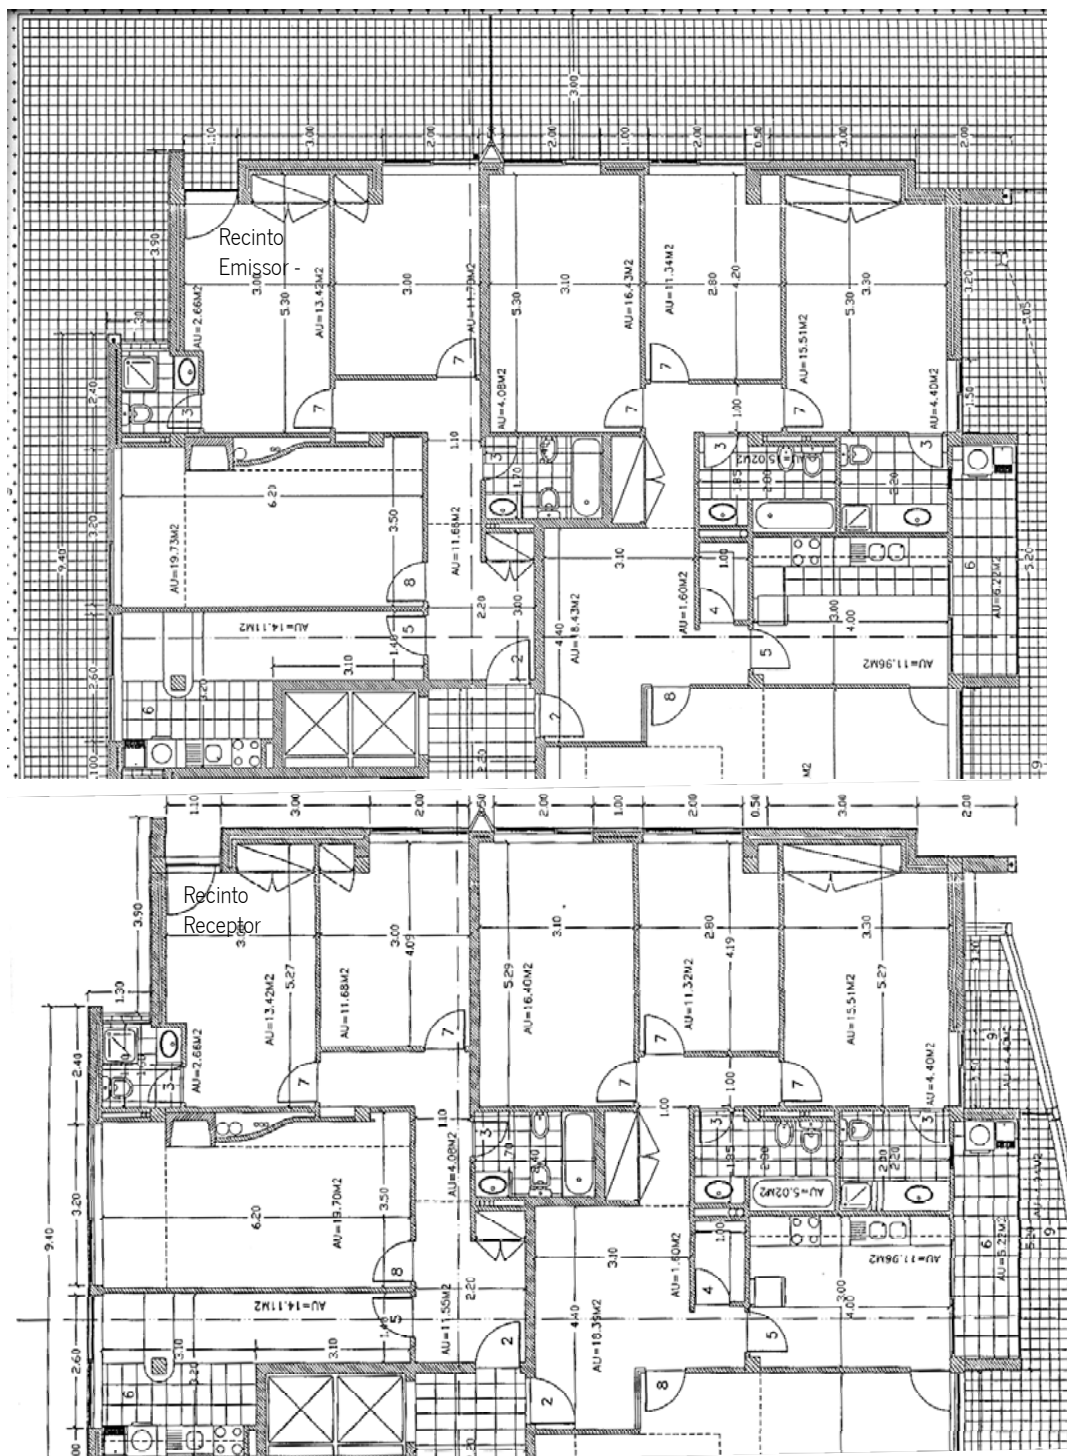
Planta do recinto emissor e do recinto receptor do ensaio de avaliação do isolamento do pavimento – Pav1
